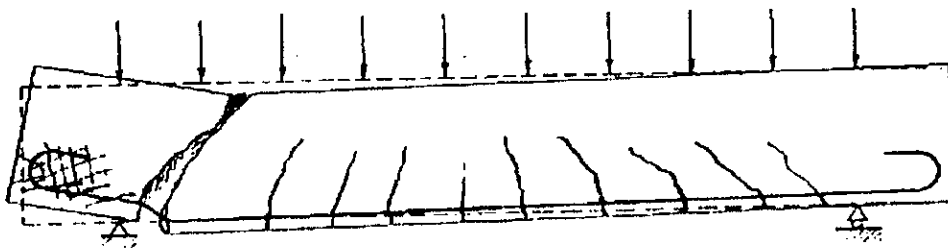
Fissuration lors de la rupture par cisaillement avec glissement.
